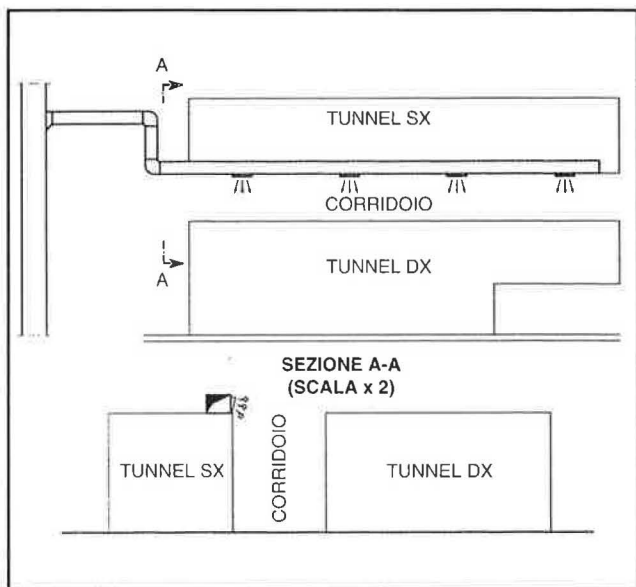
Schema delle zone di lavorazione in prossimità dei tunnel, prima dell'intervento di adeguamento
